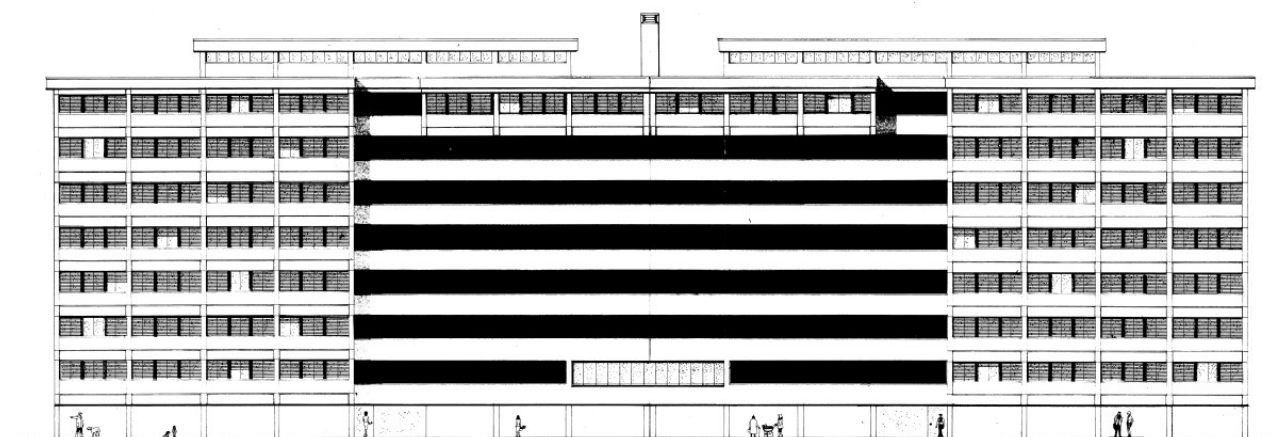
Stralcio prospetto di via Marinai d'Italia 1-3
